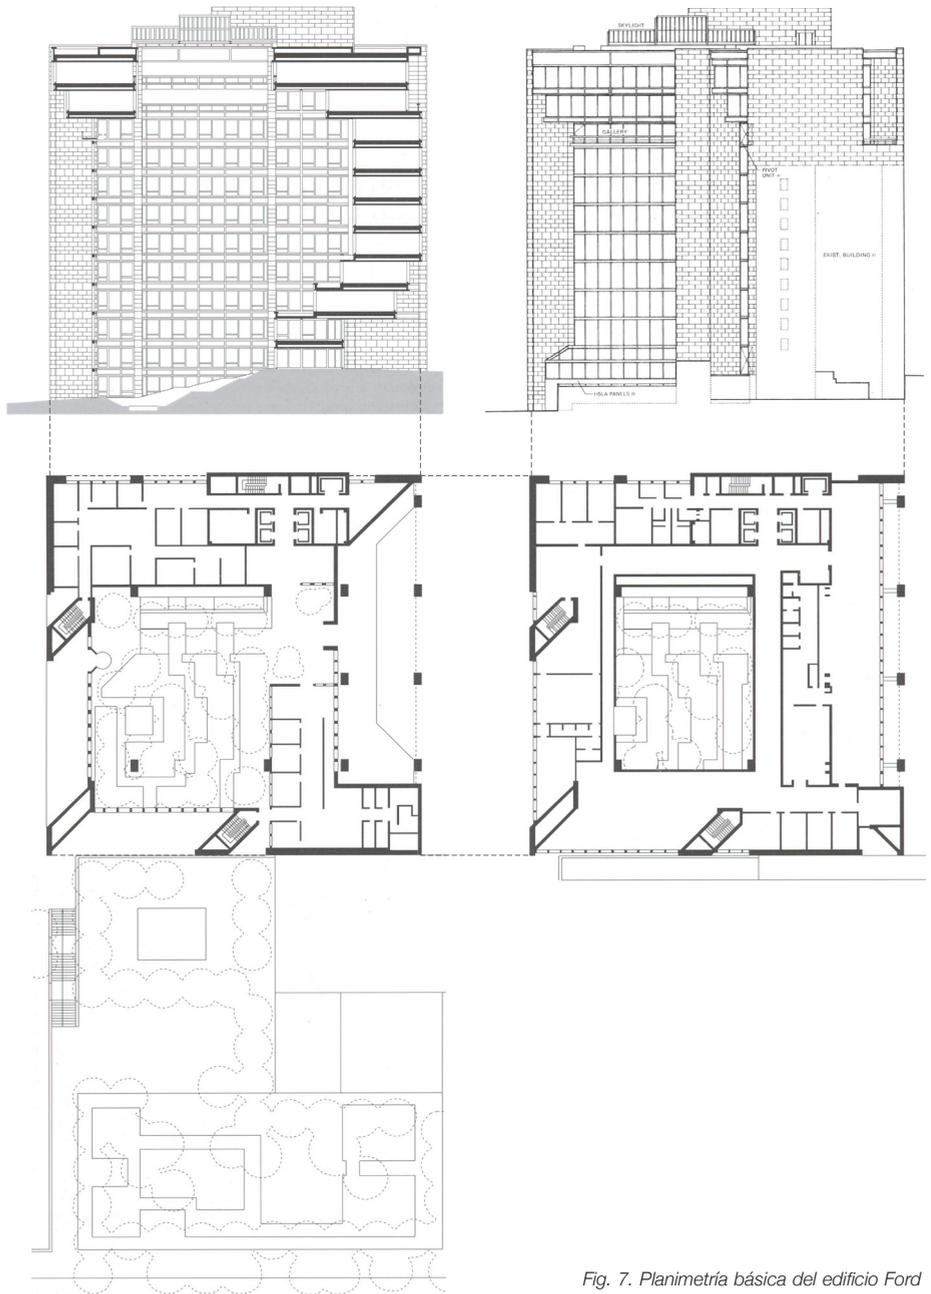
Planimetría básica del edificio Ford Foundation: arriba sección tipo y alzado suroeste a Tudor City Greens. Abajo planta baja y última planta de oficinas.
